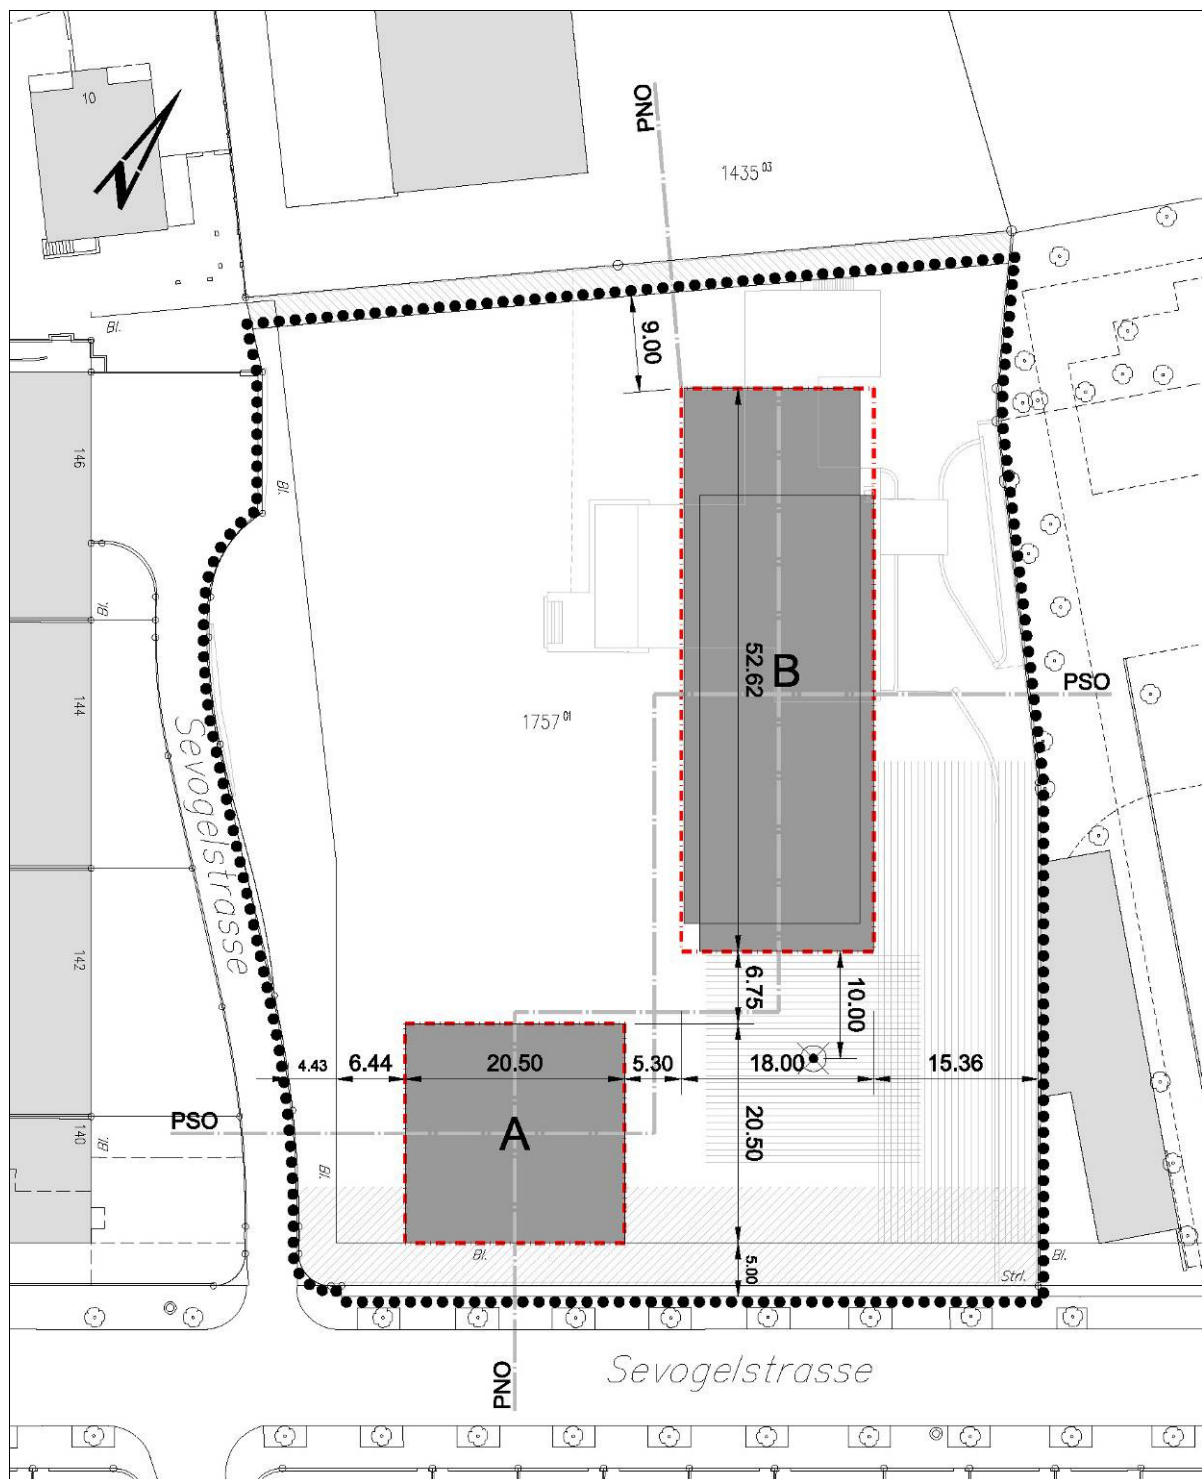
Plan-Nr. 13'191. Bebauungsplan: Situation (kein Massstab)
